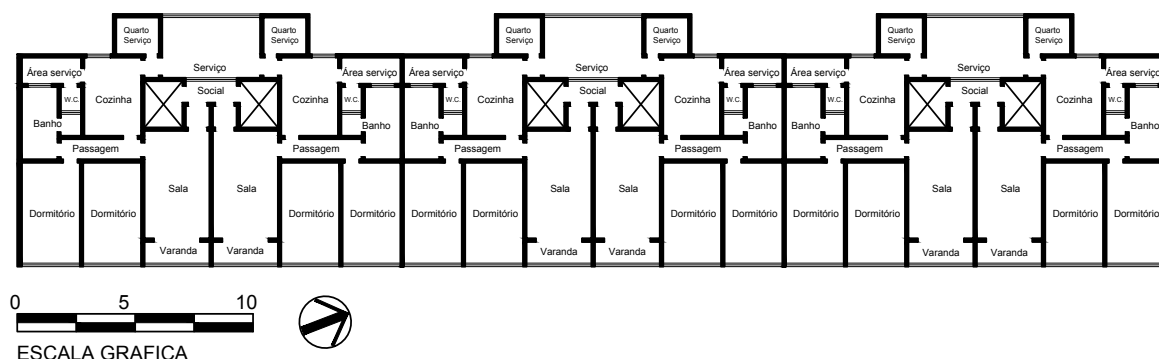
Planta baixa do pavimento tipo – Edifício Parque das Acácias
